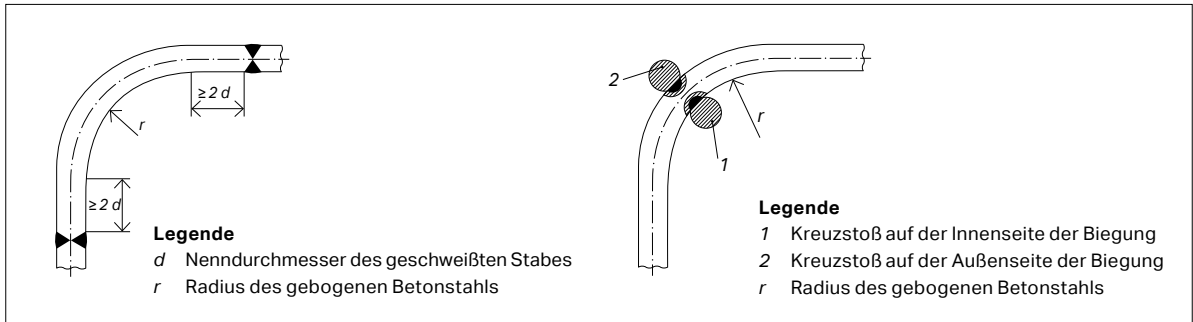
Schweißstöße in gebogenen Betonstahlstäben nach Kap. 13.2
